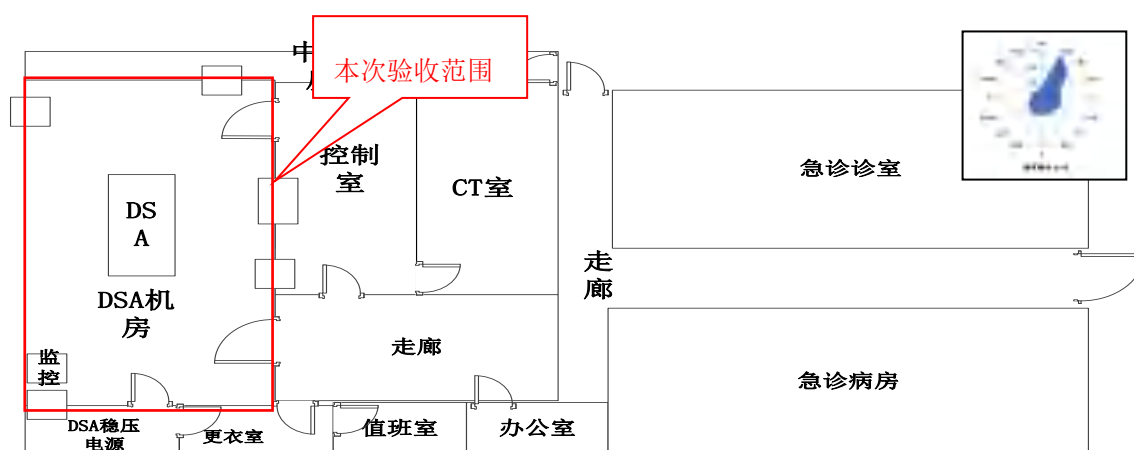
临沂市兰山区中医医院一楼急诊平面图
